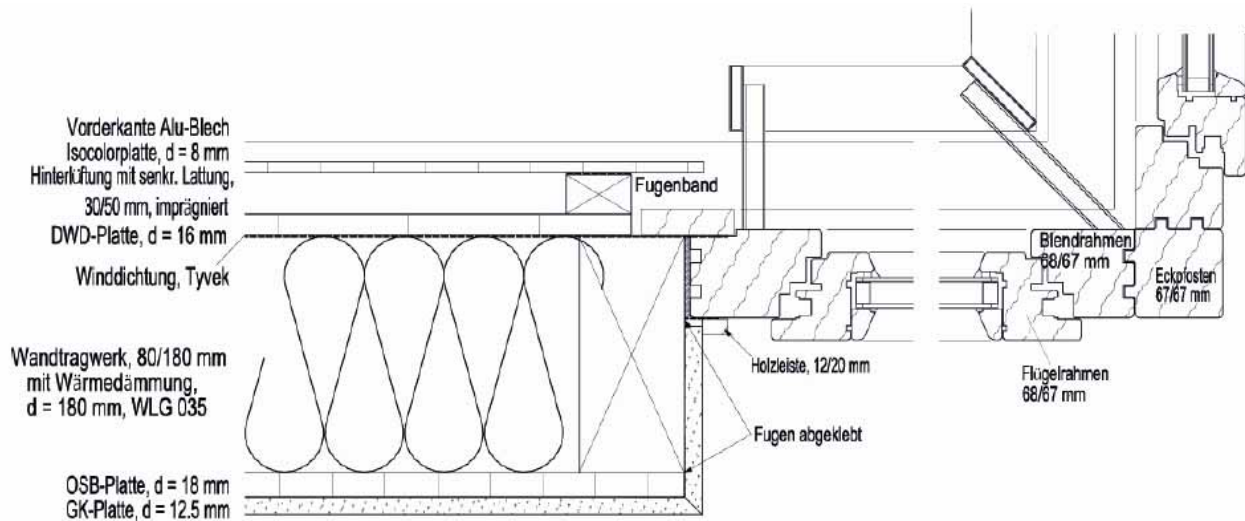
Fensterdetail Grundriss NEH [Quelle: ACMS]
